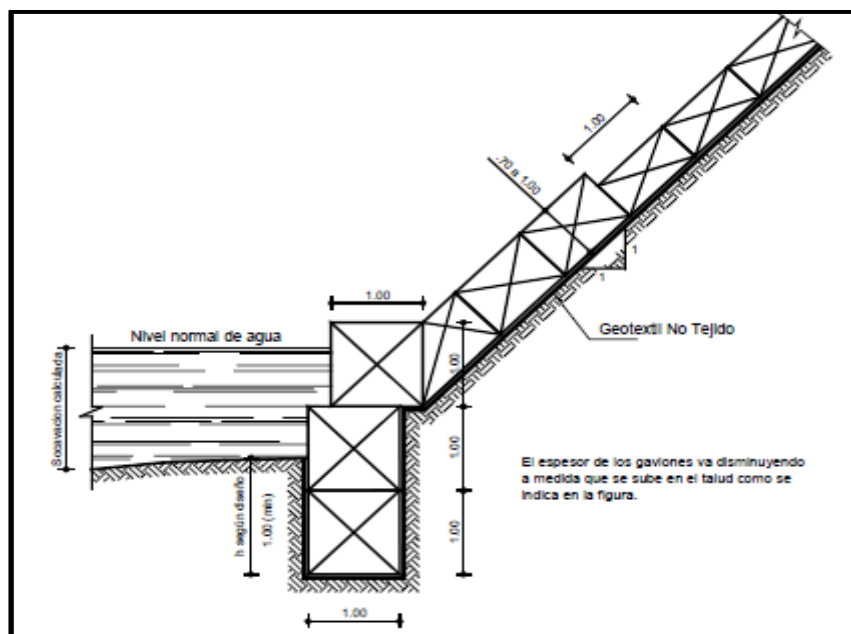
Muro de gaviones sugerido disminuyendo la pendiente del talud.
